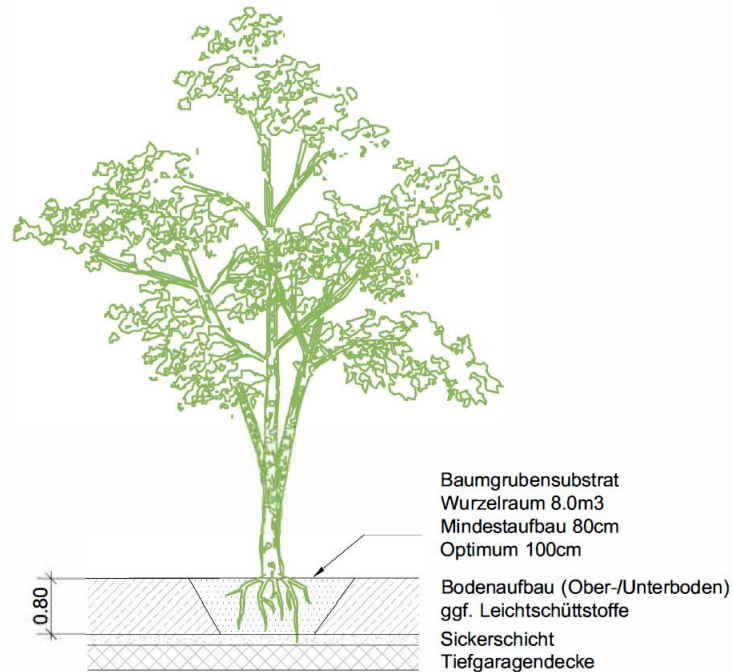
Sicherstellung Durchwurzelungsraum auf unterbauten Baubereichen (Quelle: planikum GmbH, 2020)
